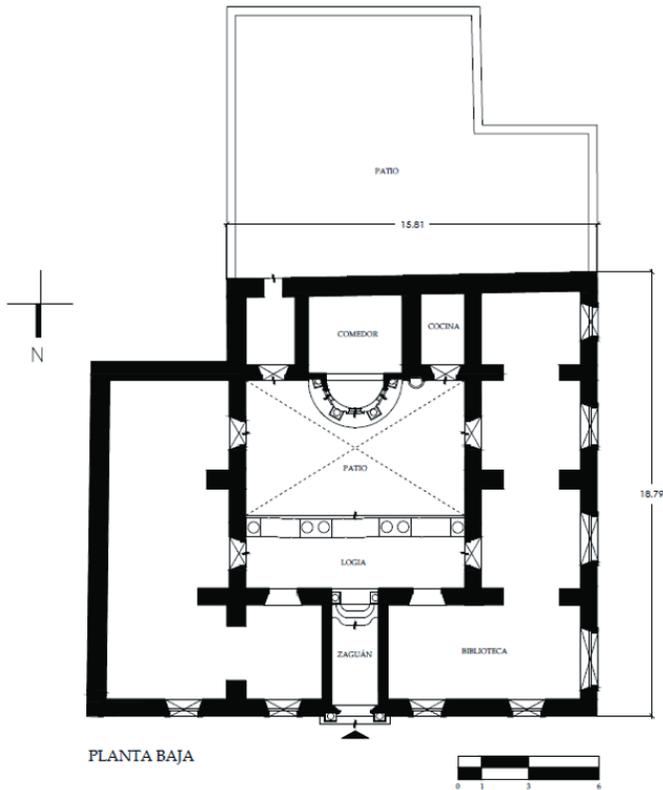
Planta arquitectónica. Levantamiento elaborado por Karina Meza de la Torre y Miguel Tejeda Mendoza.
